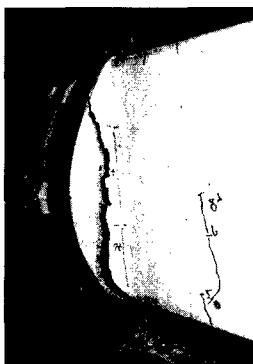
破壊状況 (No. 3 側面) 写真2 鋼板はつり後 (下面)
